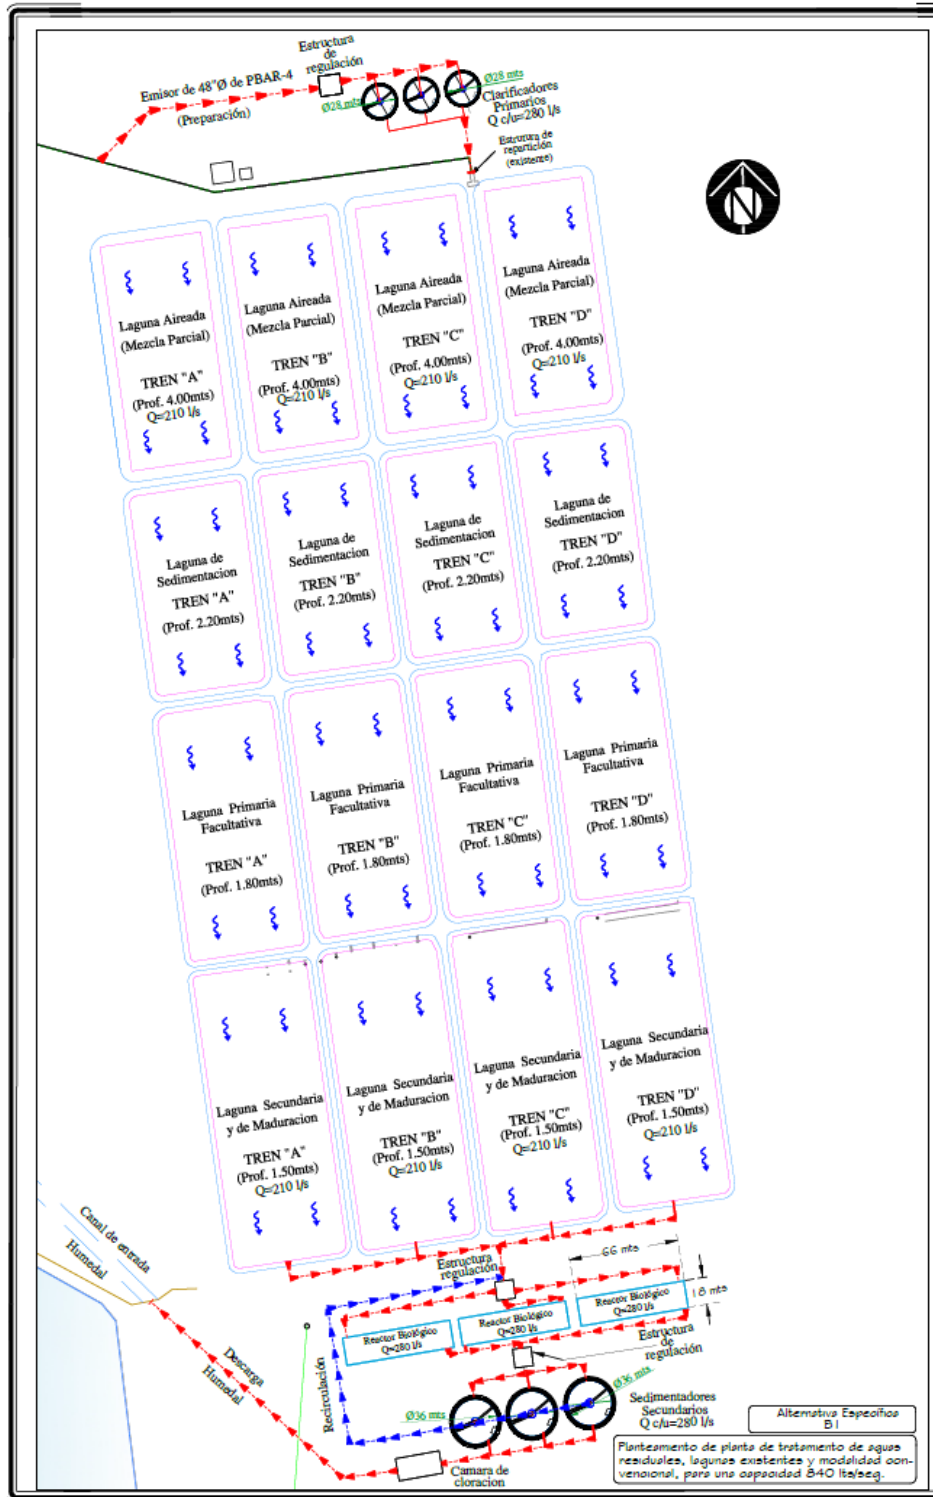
Alternativa B1. Reingeniería de la planta actual con la construcción de una planta de lodos activados convencional con una capacidad de 840 L/s.
